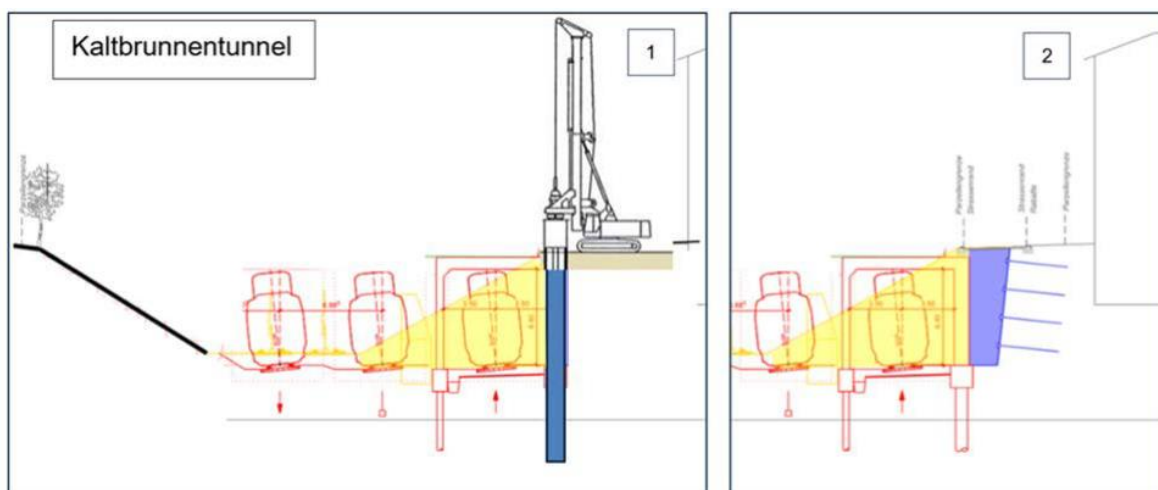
Kaltbrunnentunnel, Ausführungsvariante Baugrubenabschluss mit 1 Bohrpfahlwand und 2 konventionelle Nagelwand
